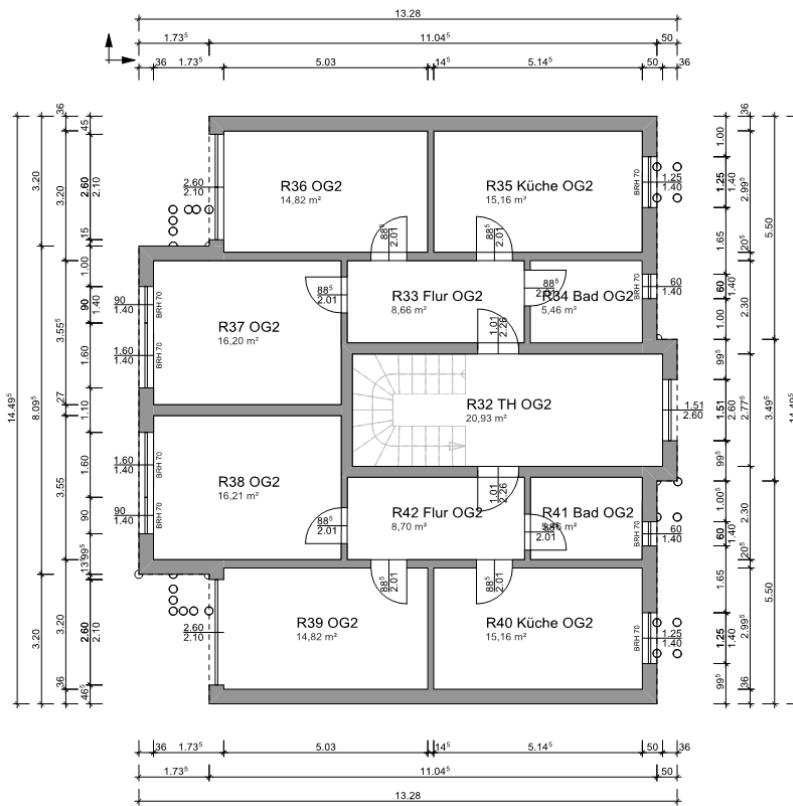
Grundriss 2. Obergeschoss Mehrfamilienhaus
